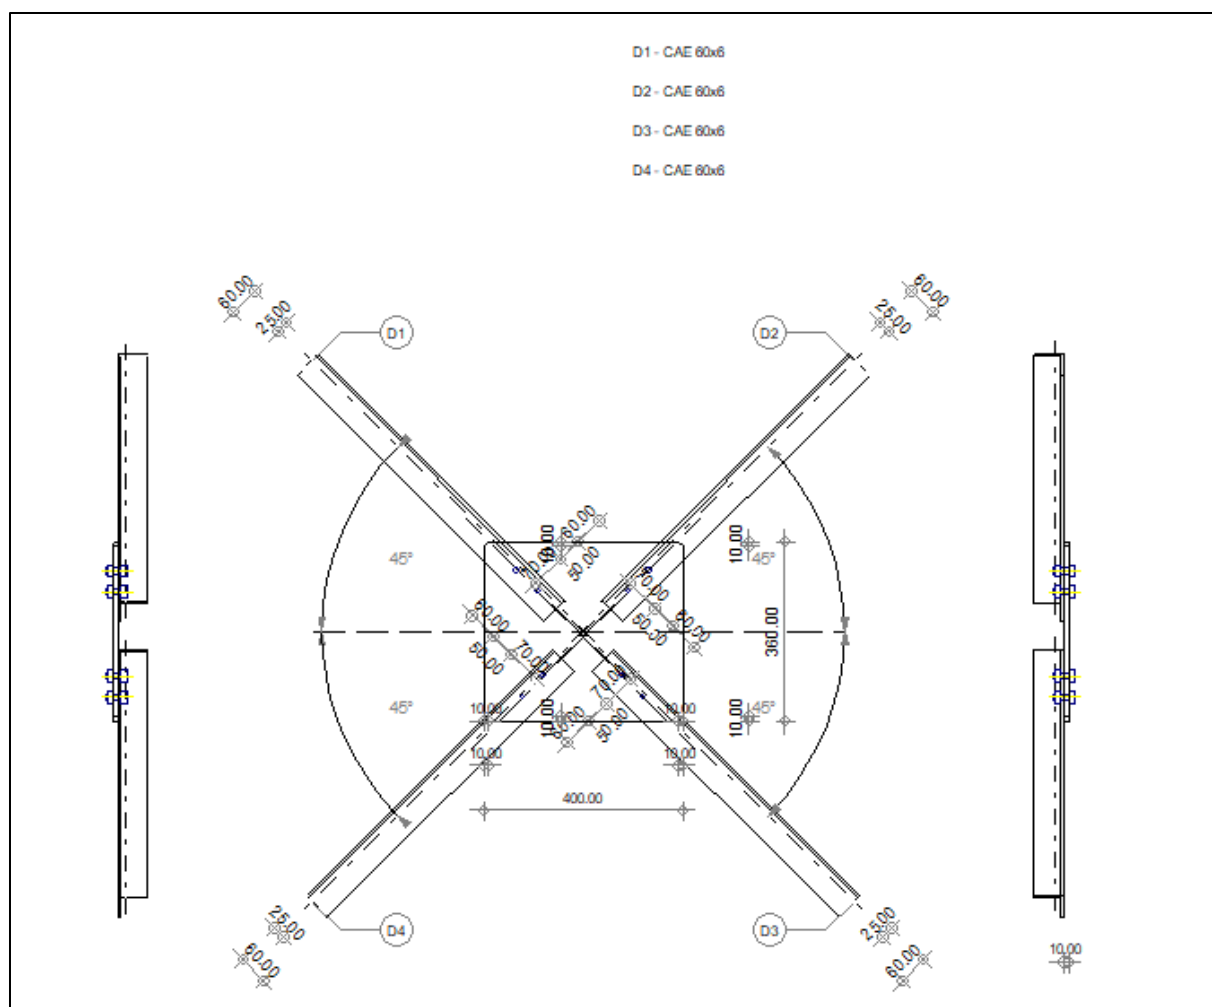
Schéma de l'assemblage de la poutre au vent.
